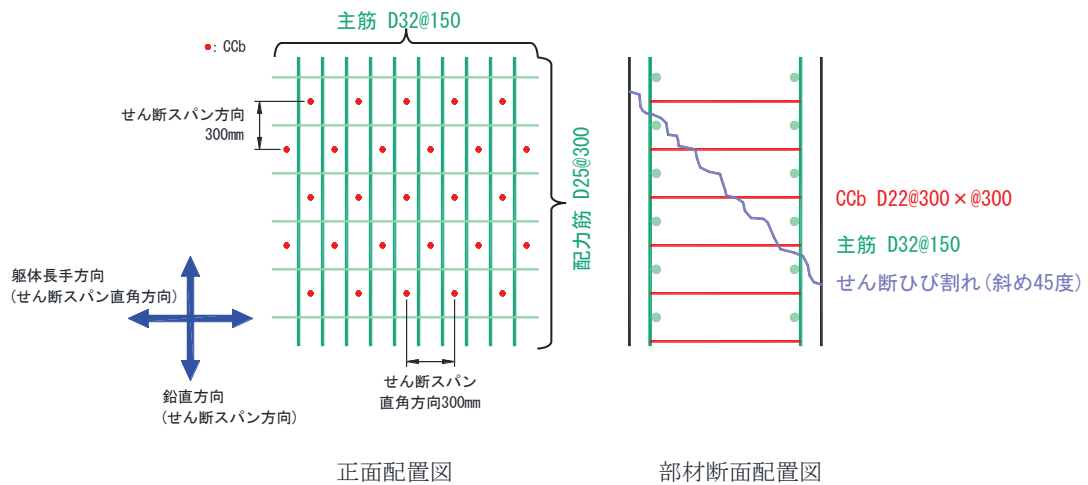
取水路（漸拡部）のせん断補強筋正面配置図及び部材断面配置図
